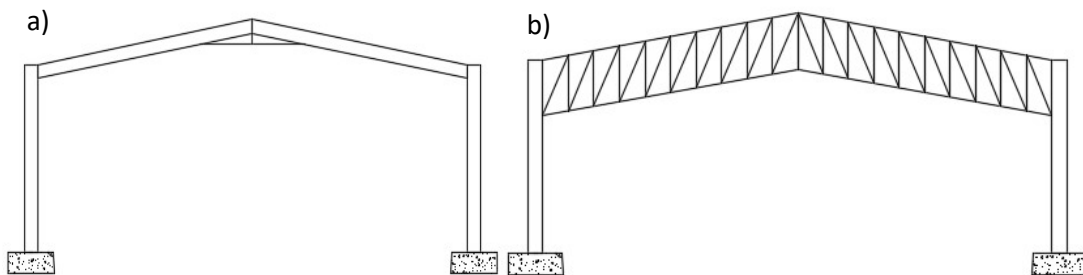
a) Pórtico simples; b) Pórtico treliçado.
